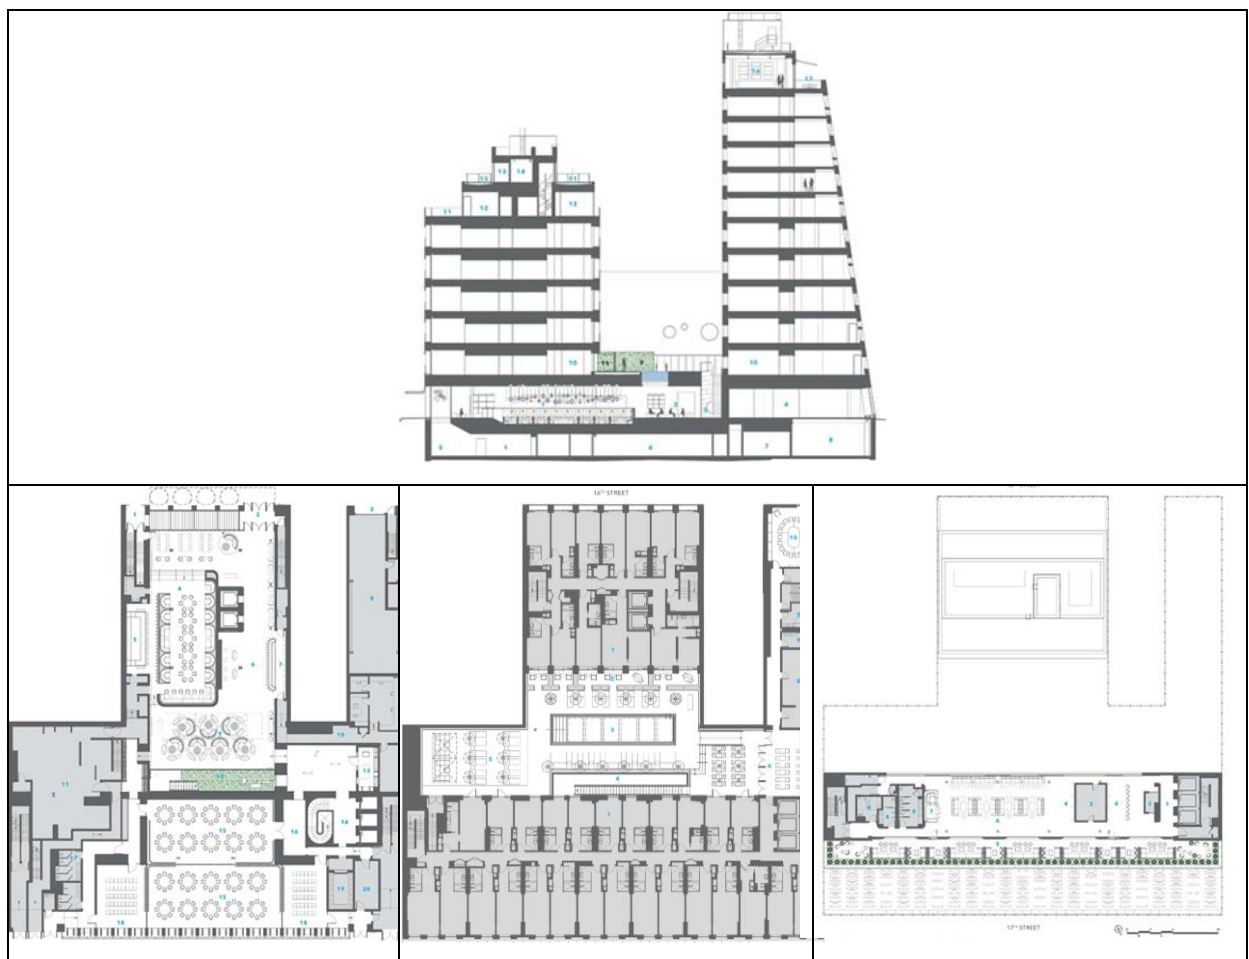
План першого, другого та дванадцятого поверхів та розріз готелю
